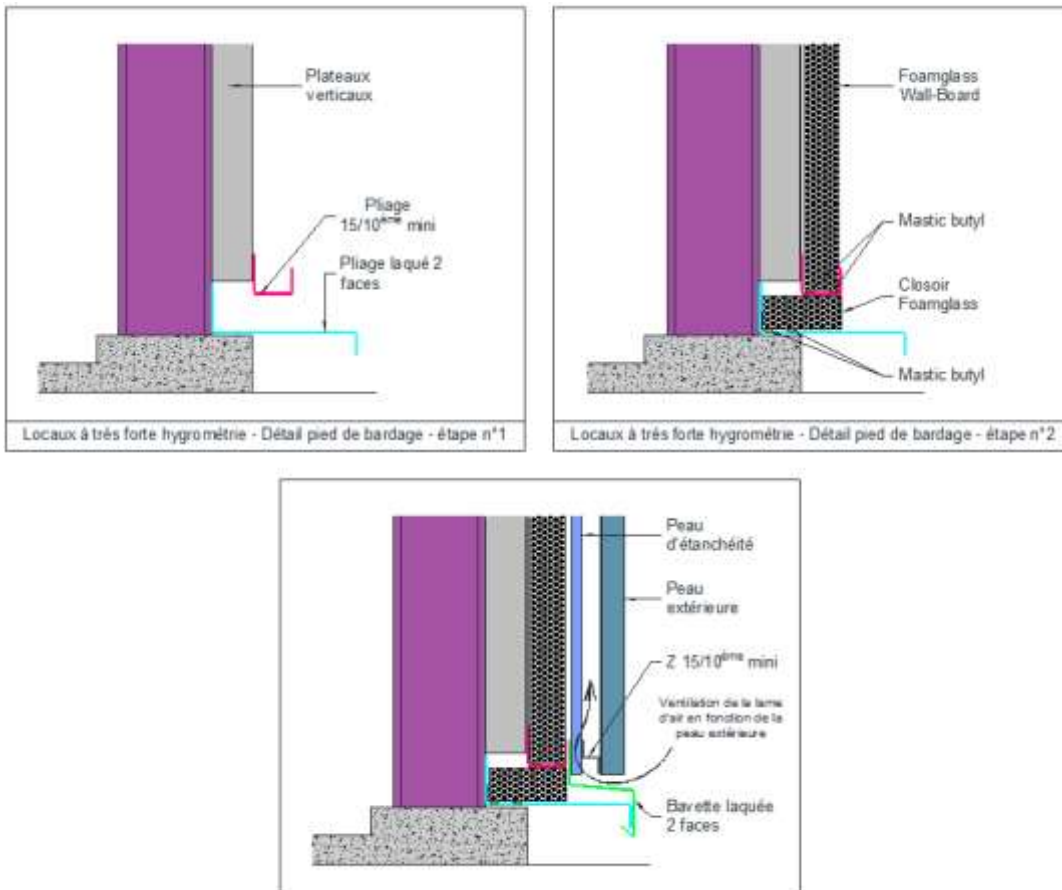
Coupe sur bardage triple peau en partie basse (plateaux verticaux)
